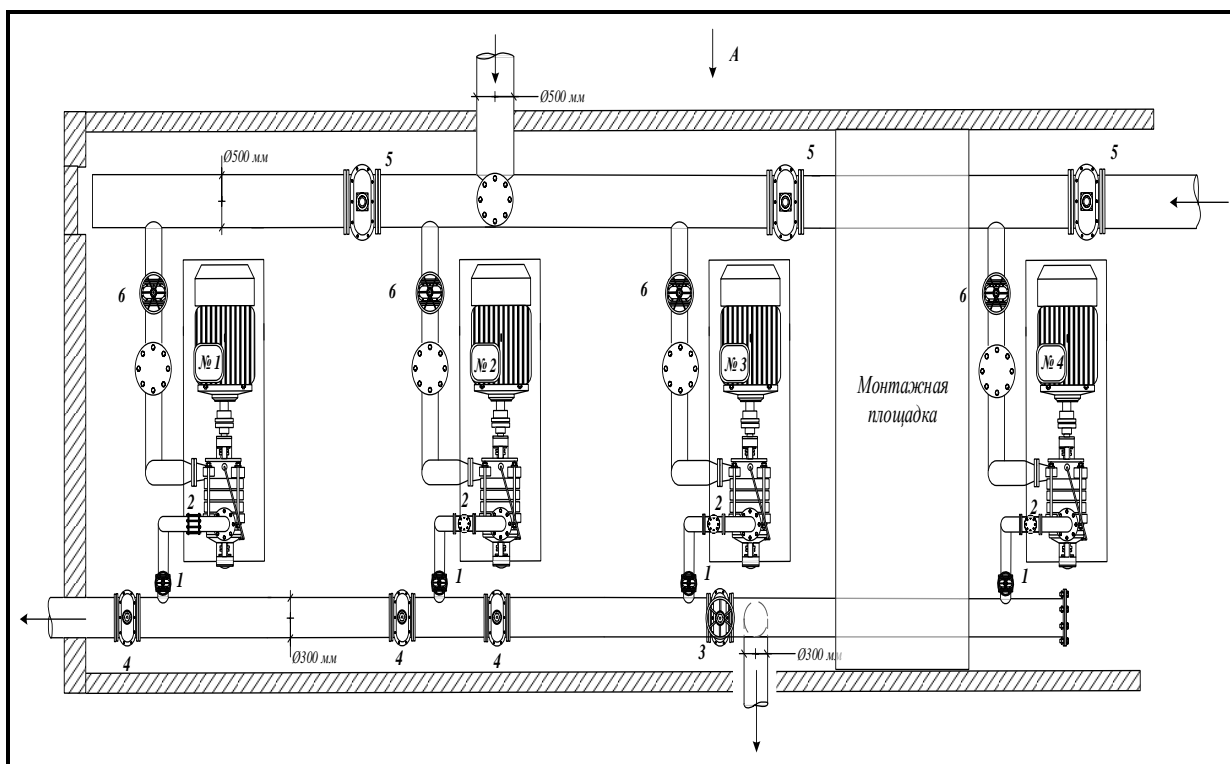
Схема размещения насосных агрегатов и трубопроводов в машинном зале здания главной водопроводной насосной станции, обеспечивающих подачу воды в третью зону города Петропавловск-Камчатский.
